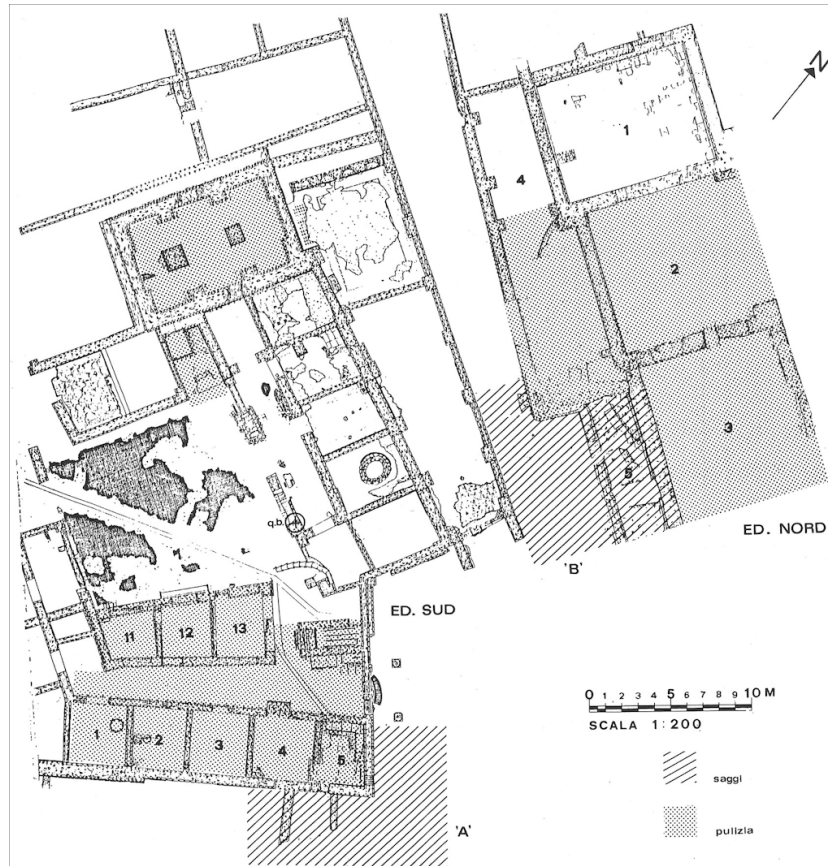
Iseo di Porto: Planimetria delle strutture (da LAURO 1987)
